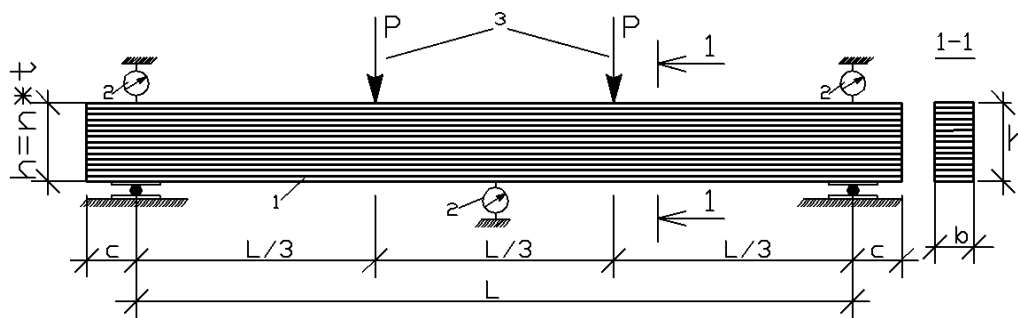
Схема испытания на статический изгиб клееной балки.
